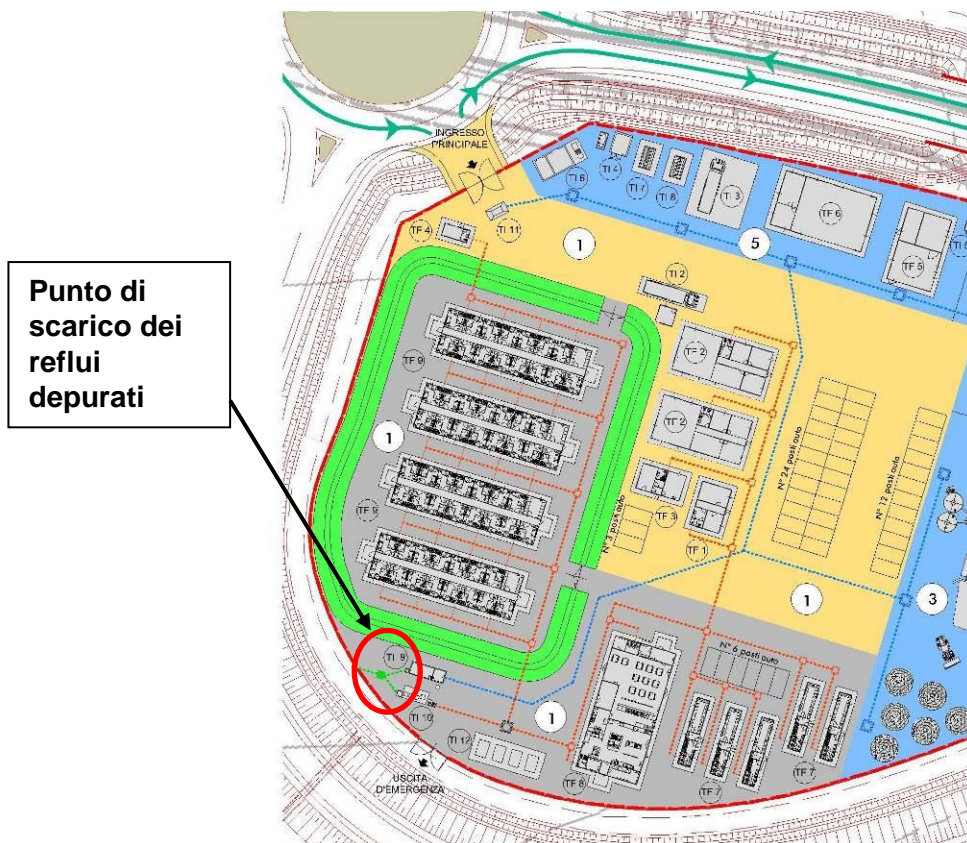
Stralcio planimetrico del campo base con individuato il punto di scarico dei reflui depurati
